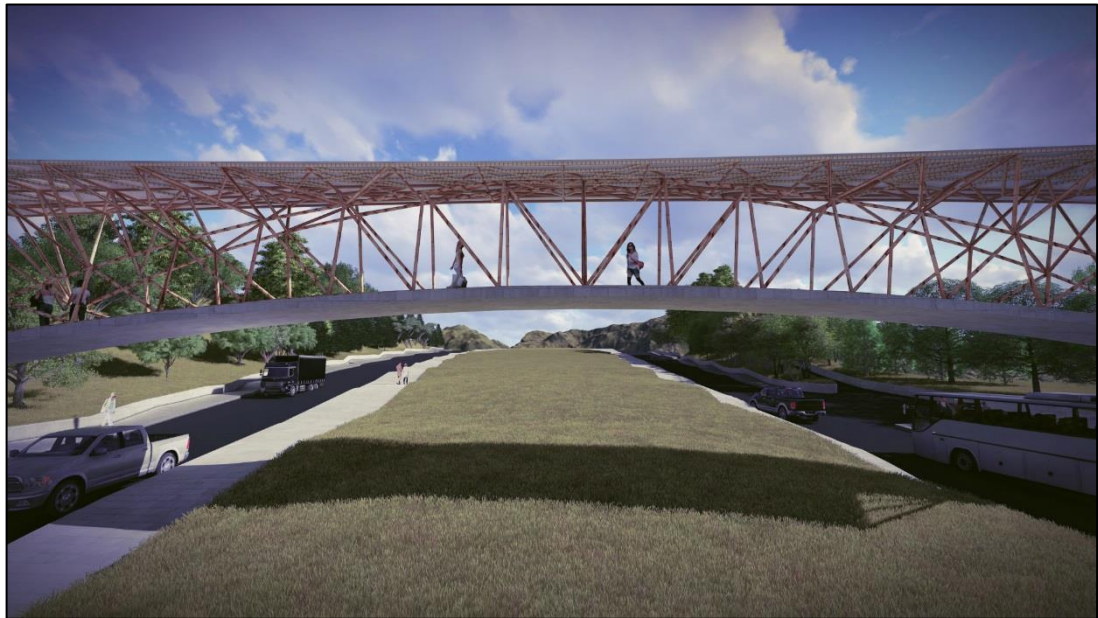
Render arquitectónico de detalle del tablero y la pendiente
